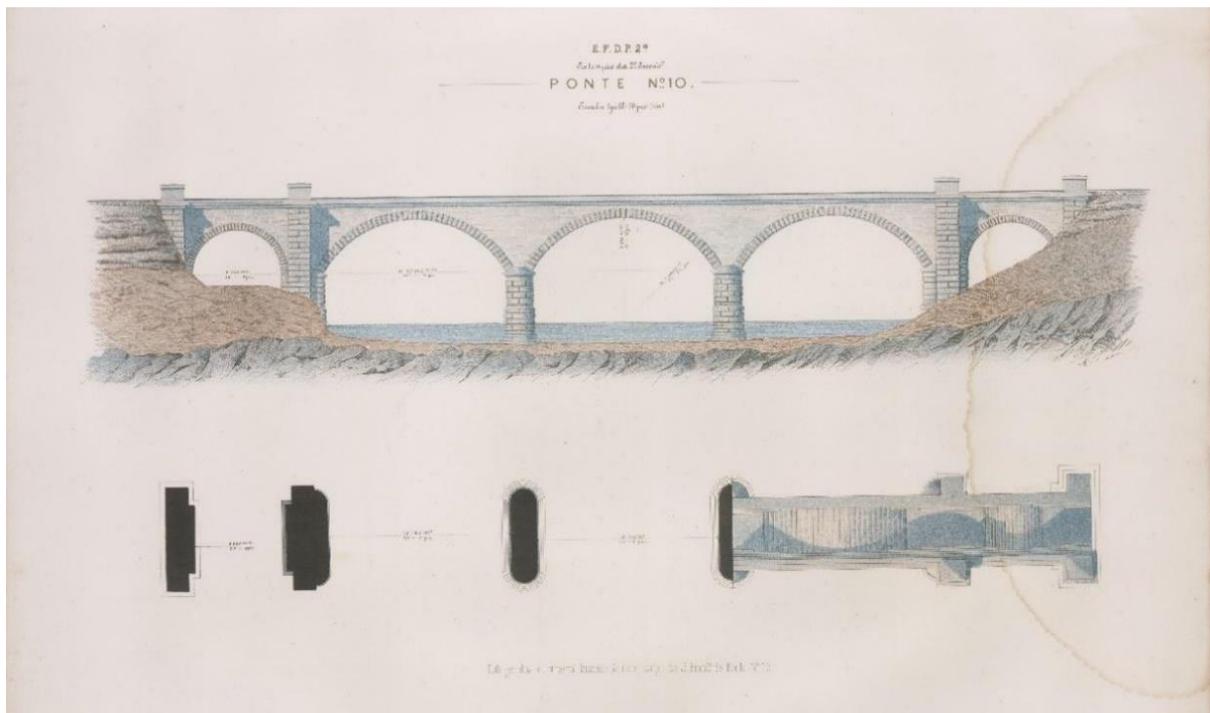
LINDE, Carlos. Brasil: Estrada de Ferro de D. Pedro II.: Ponte n. 10, extensão da 2. secção. Rio de Janeiro, RJ: Typ. Do Imperial Instituto Artístico, [1867?]. 1 planta, il.; col. (litograv.).
